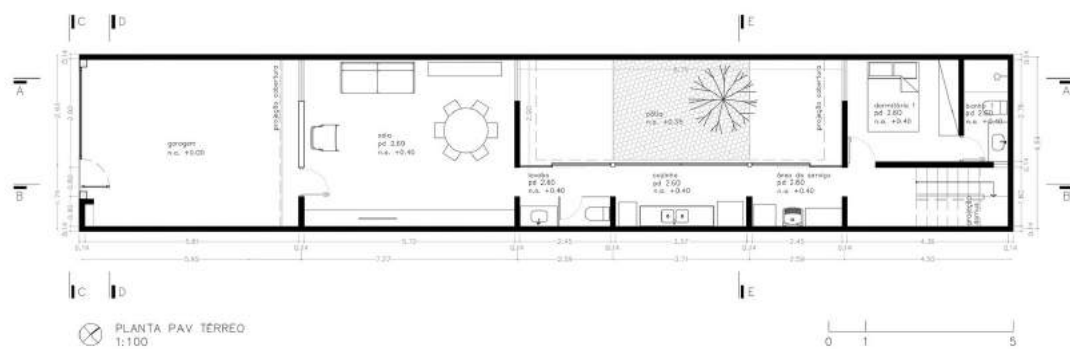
Planta “Casa Vila Matilde”: piso térreo.
